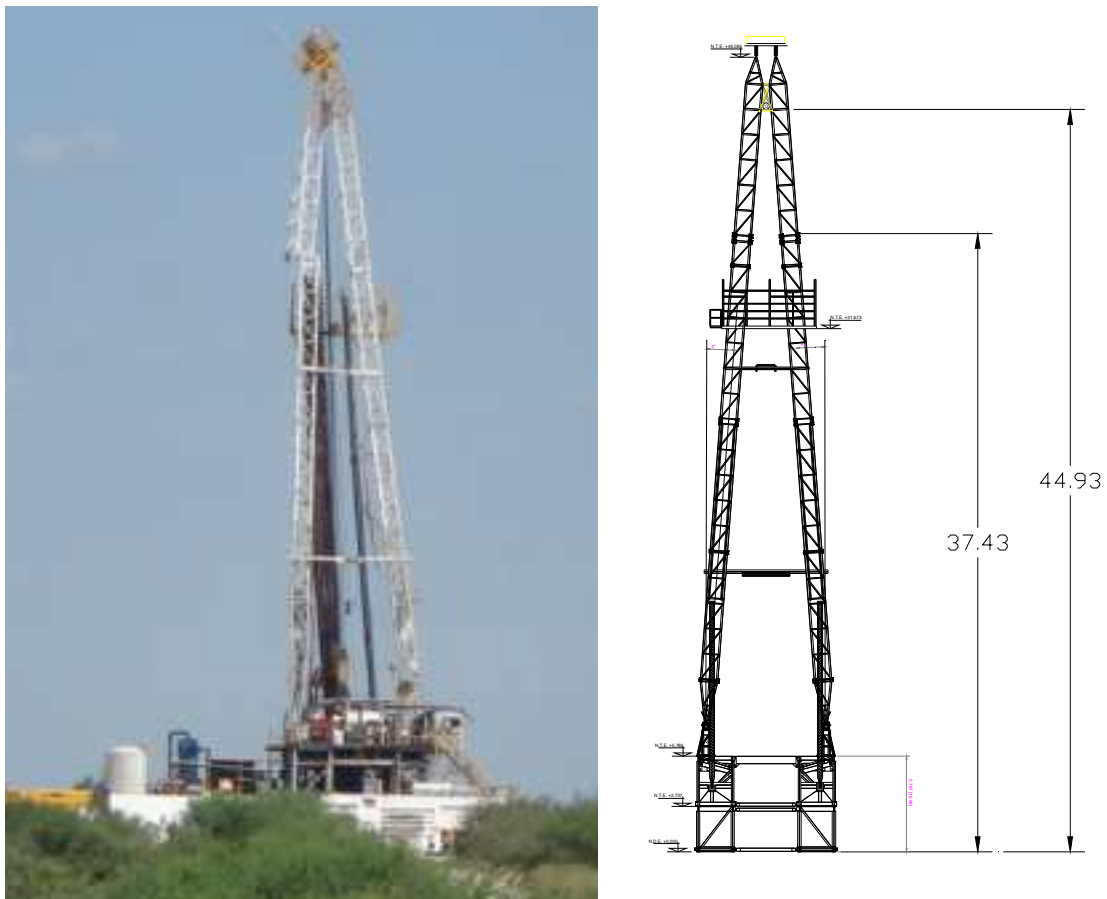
Ubicación de las zonas colapsadas (cotas en metros).
